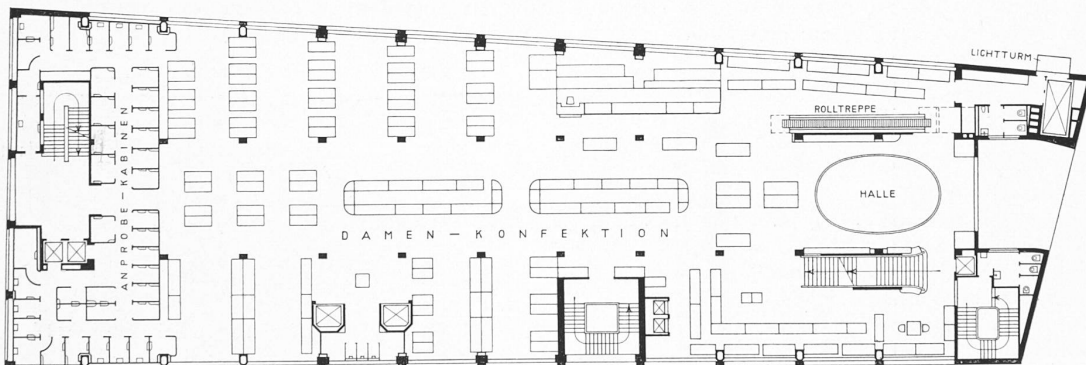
Grundriss des ersten Stockes. — Masstab 1 : 500.
